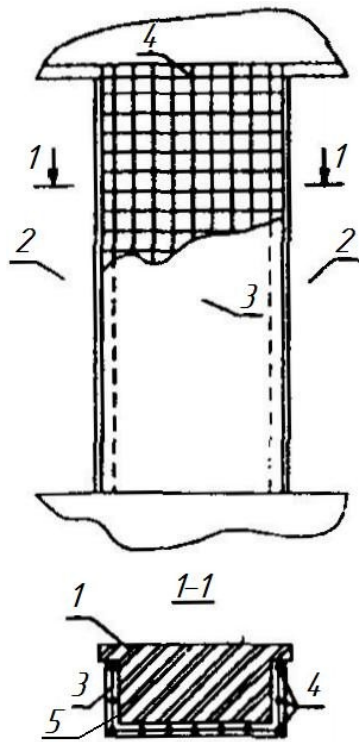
Улаштування штукатурної або залізобетонної сорочки: 1 – посилюваний простінок; 2 – прорізи; 3 – сорочка штукатурна або залізобетонна; 4 – арматура; 5 – підготовлена поверхня
